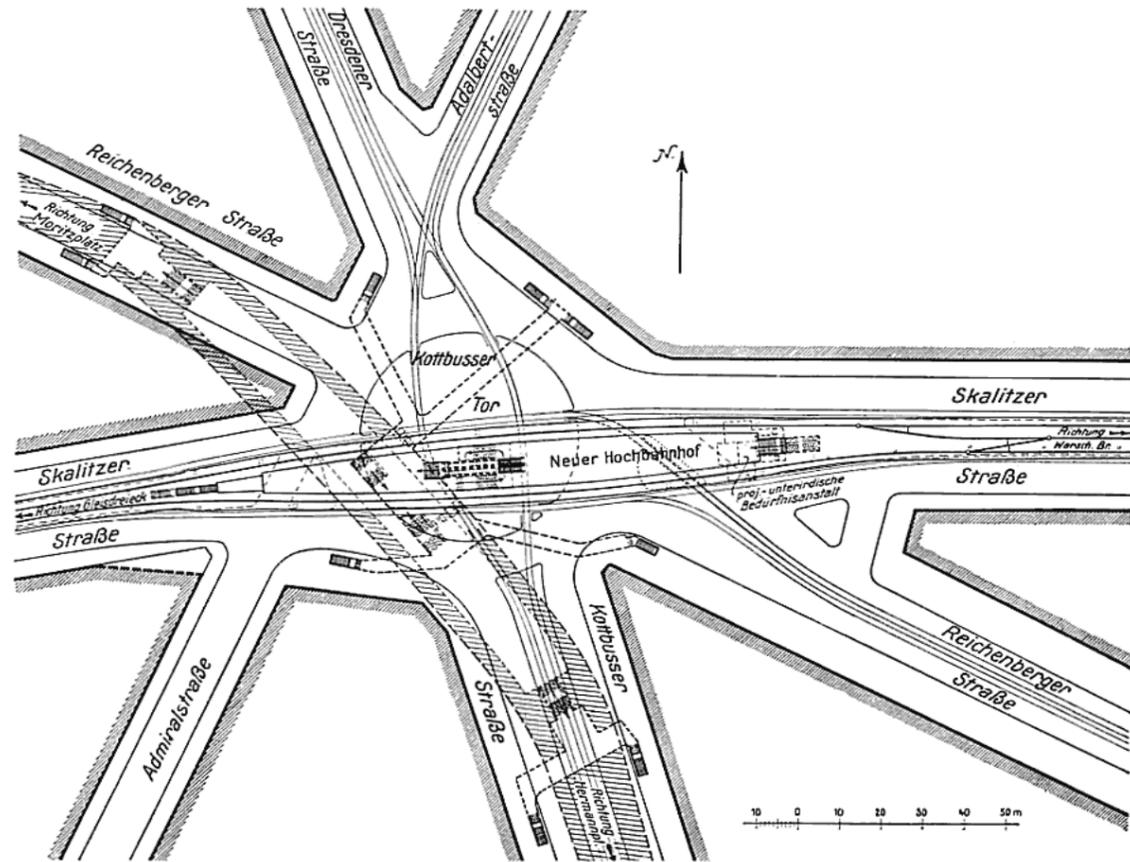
Bahnhof Kottbusser Tor, Lageplan.
